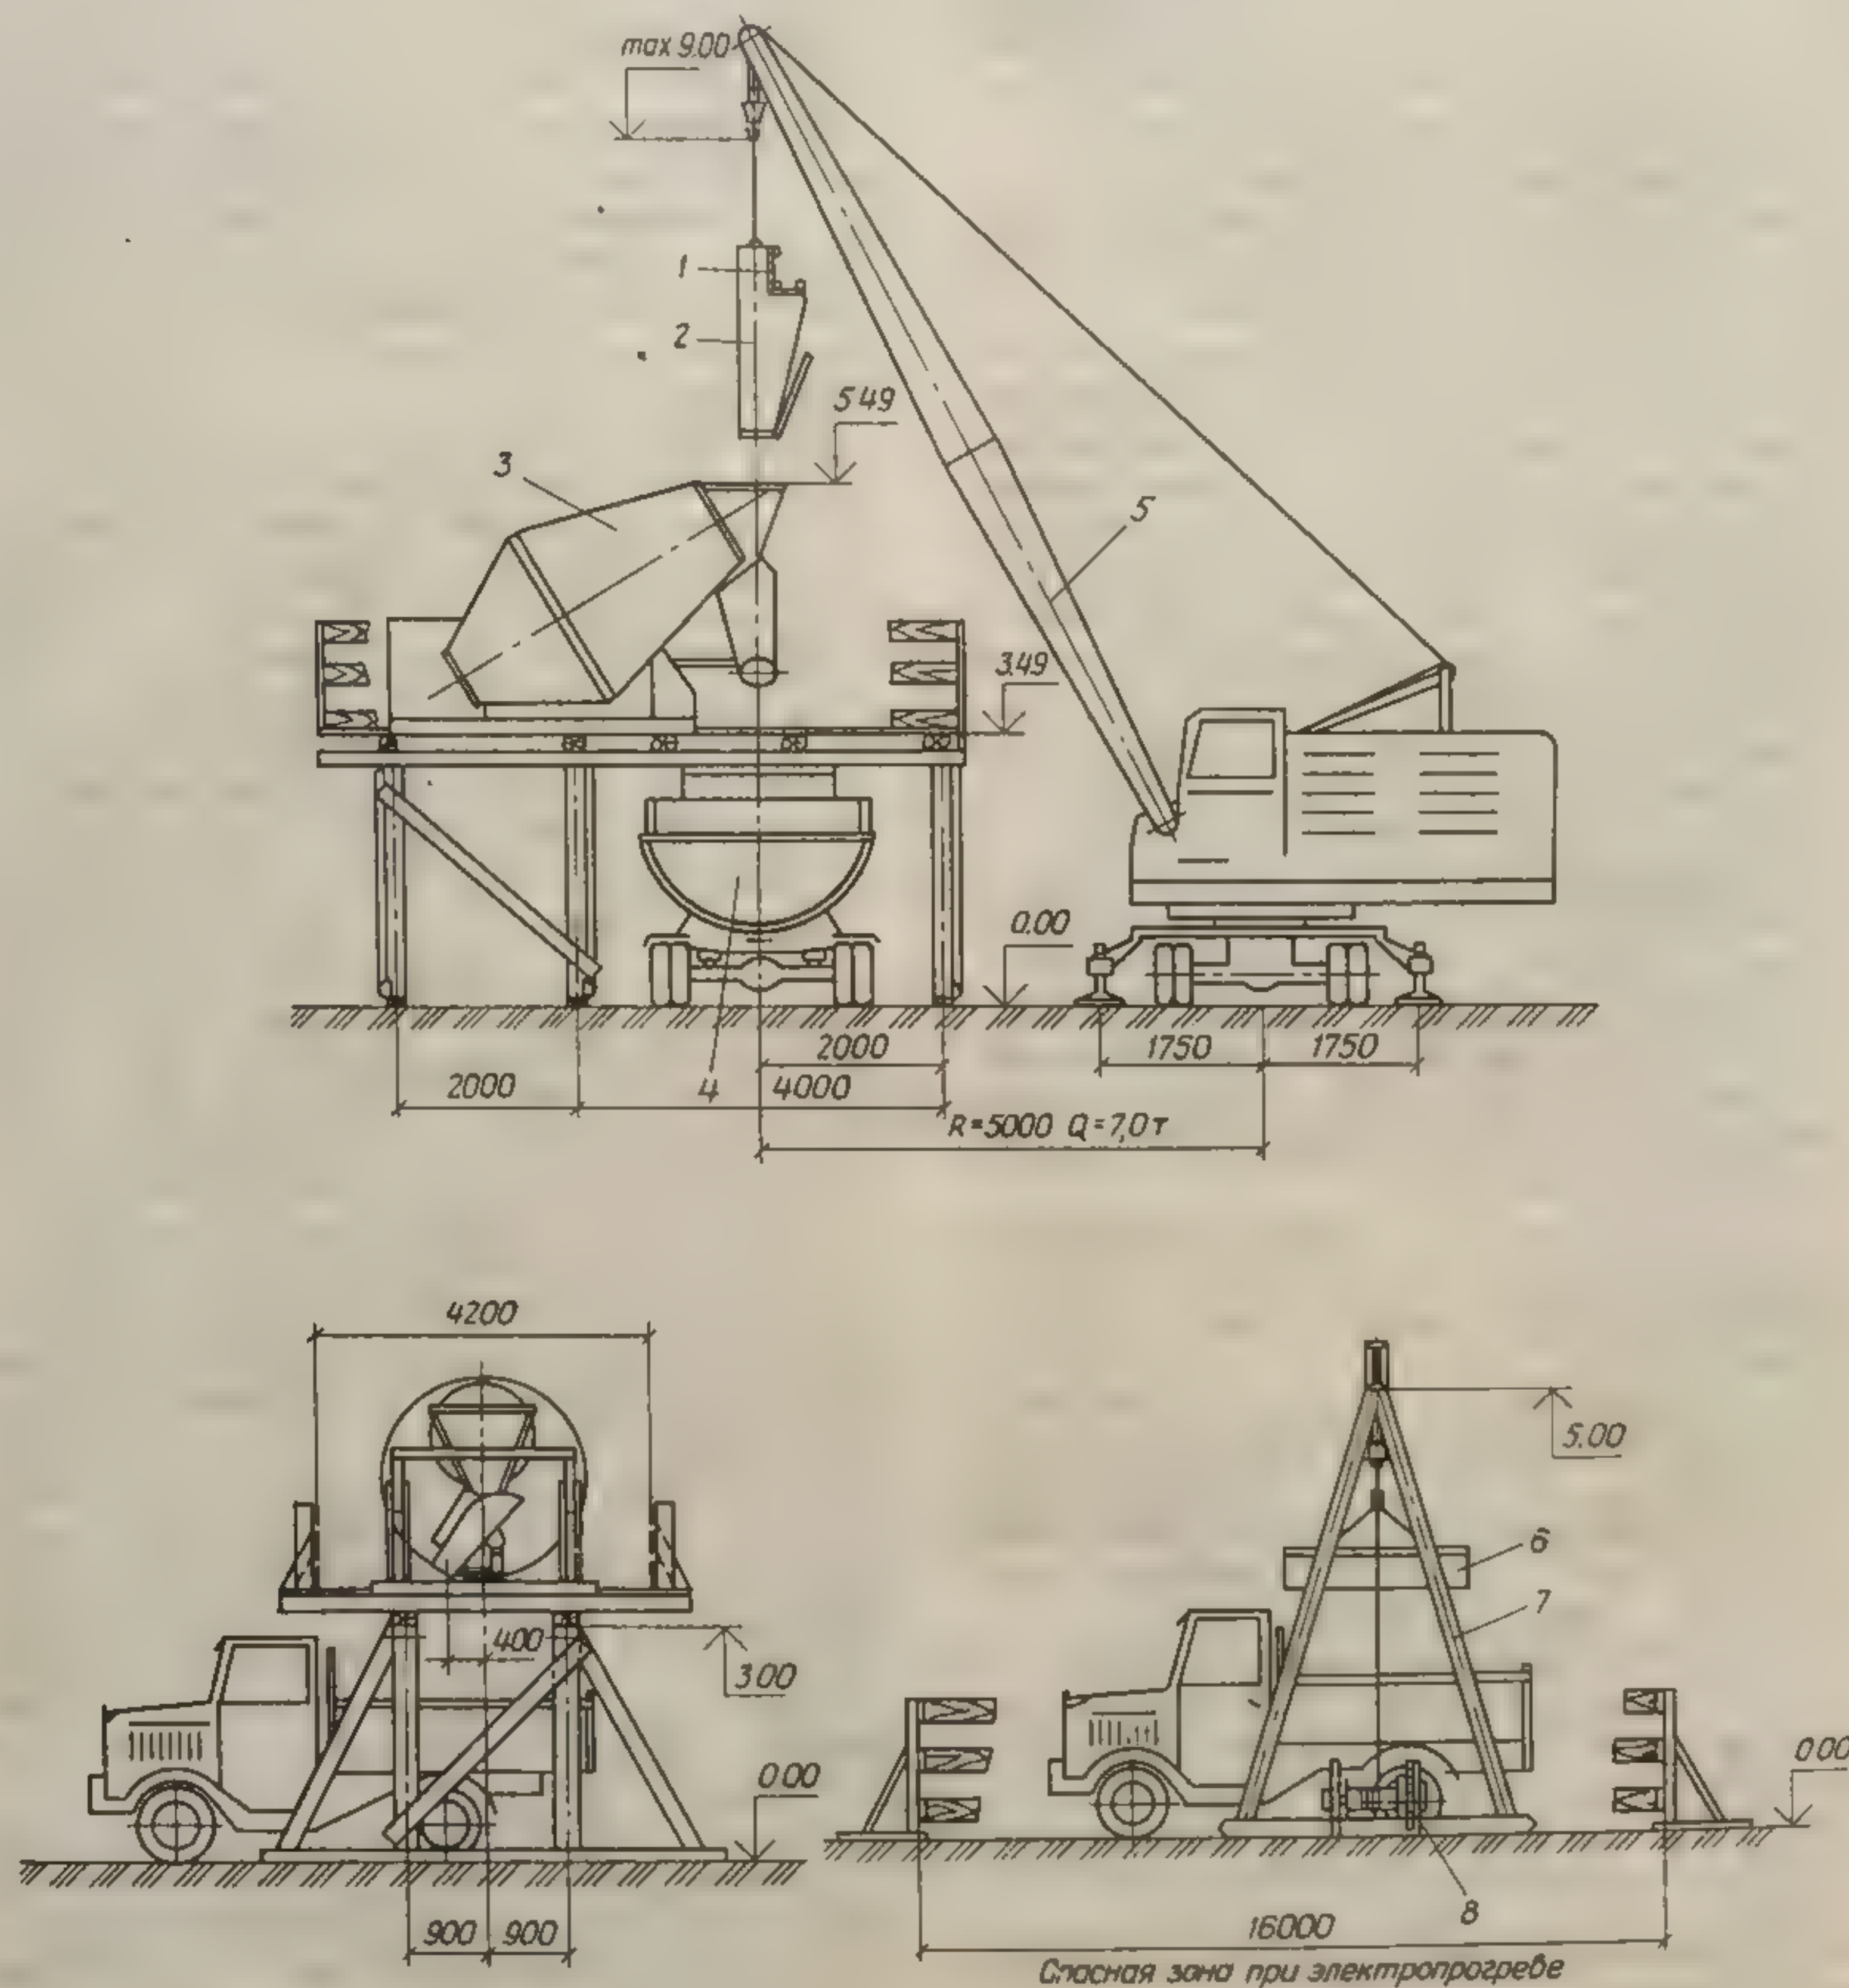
Приготовление подогретой бетонной смеси для бетонирования опор зимой:
